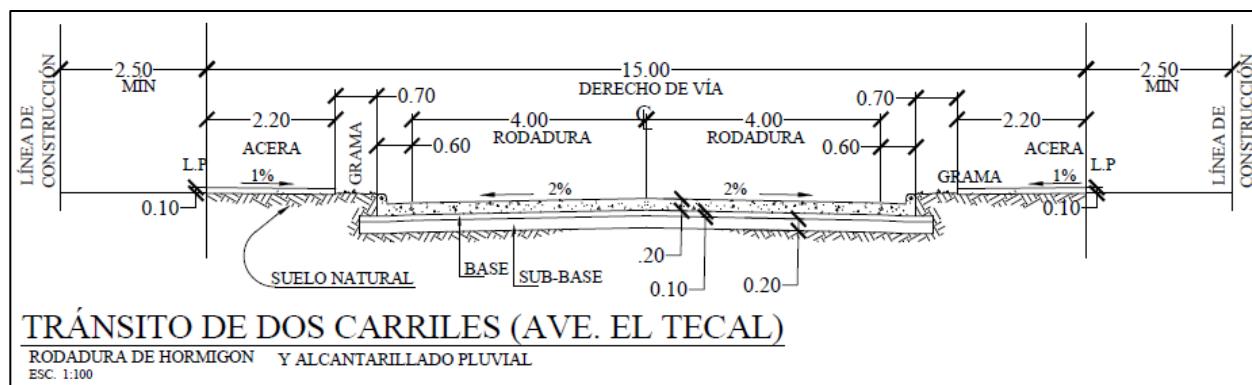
Detalle (sección) de la Avenida El Tecal. Fuente: Planos del proyecto.
